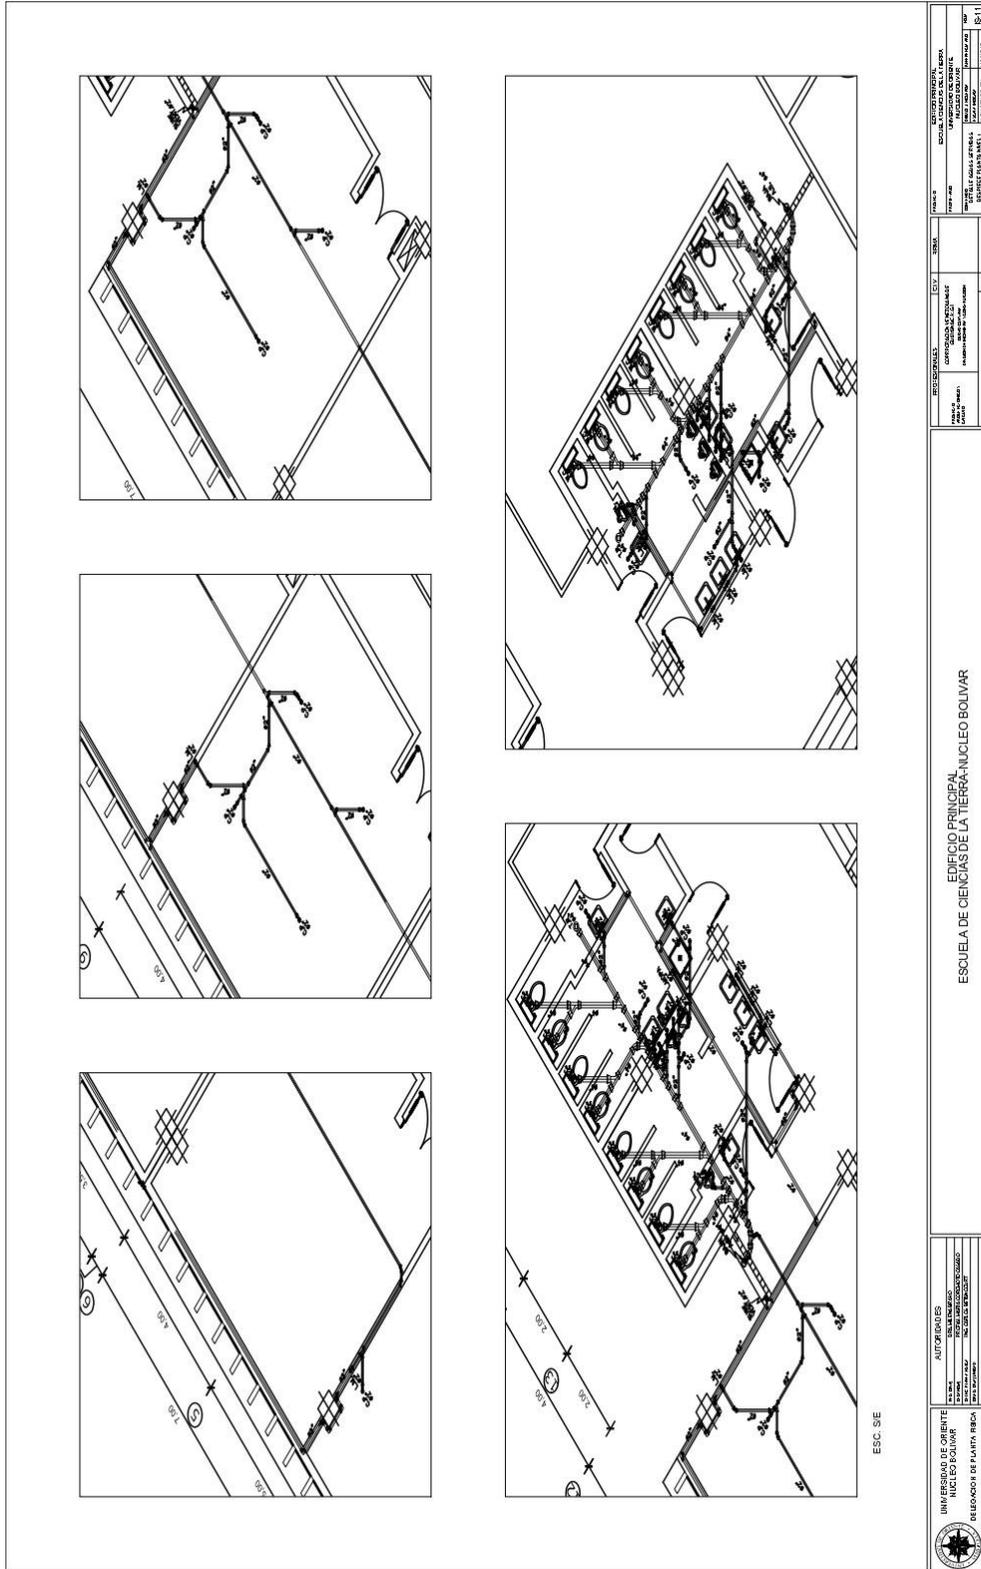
Detalle Aguas Servidas Despiece Planta Nivel 1
